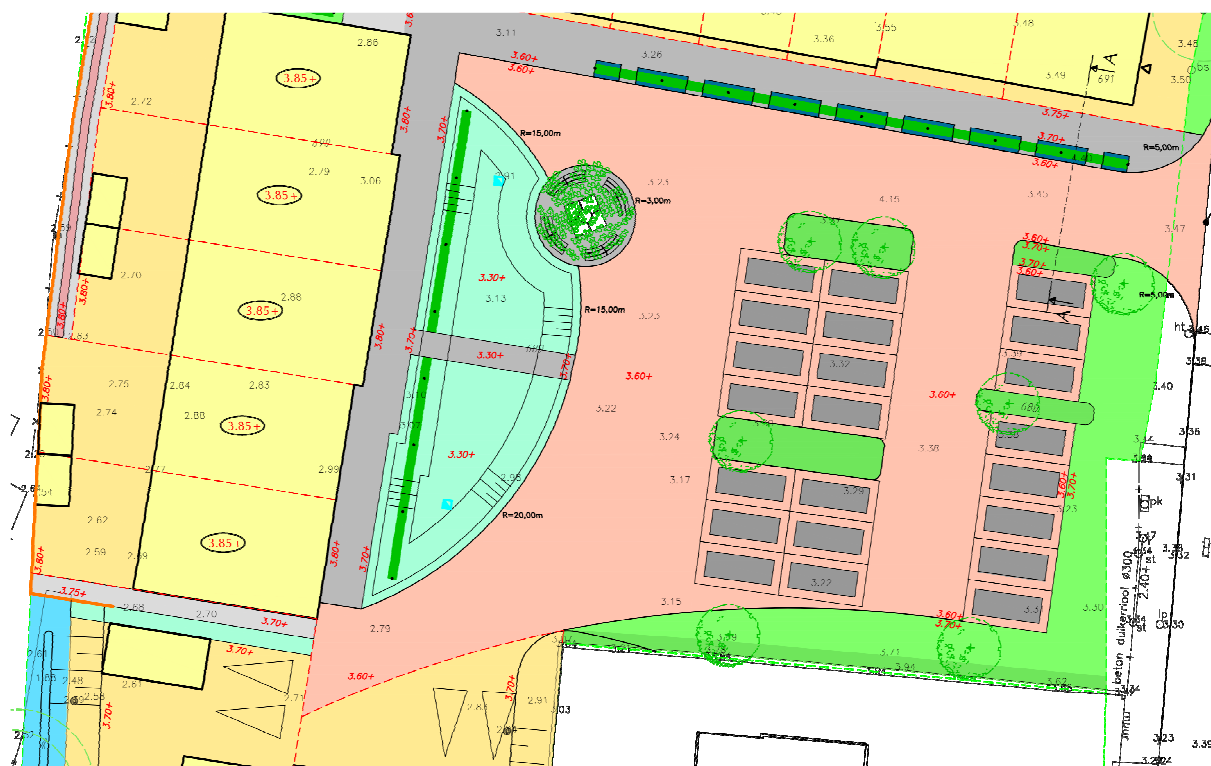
Bouwplan en peilen noordelijk deel plangebied.
